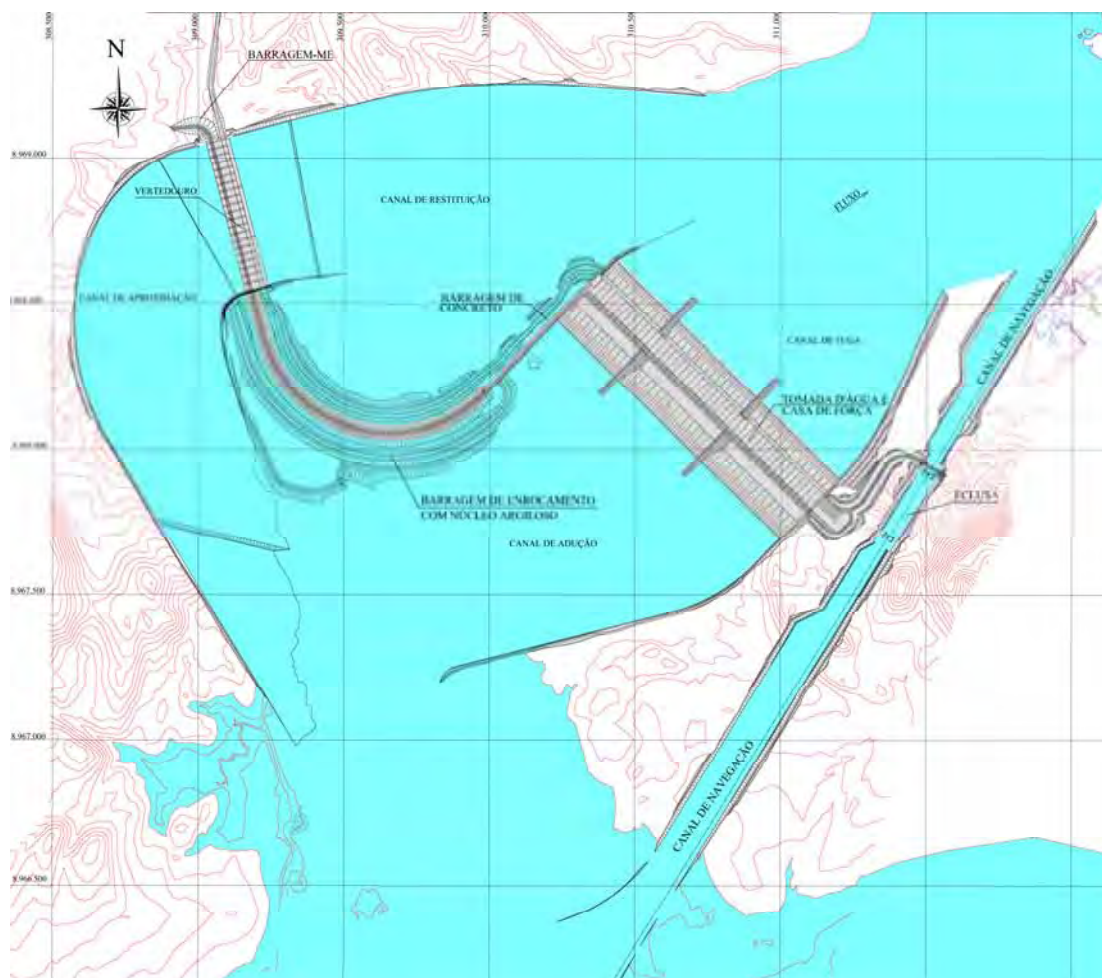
AHE Jirau: Arranjo das obras civis em planta.
